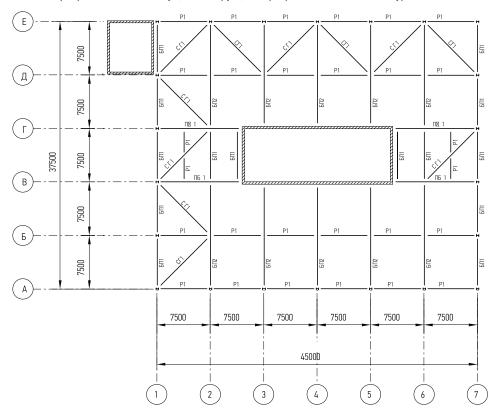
Вариант каркаса с применением стальных конструкций при сетке 7,5х15 м. Маркировочный план несущих конструкций кровли
